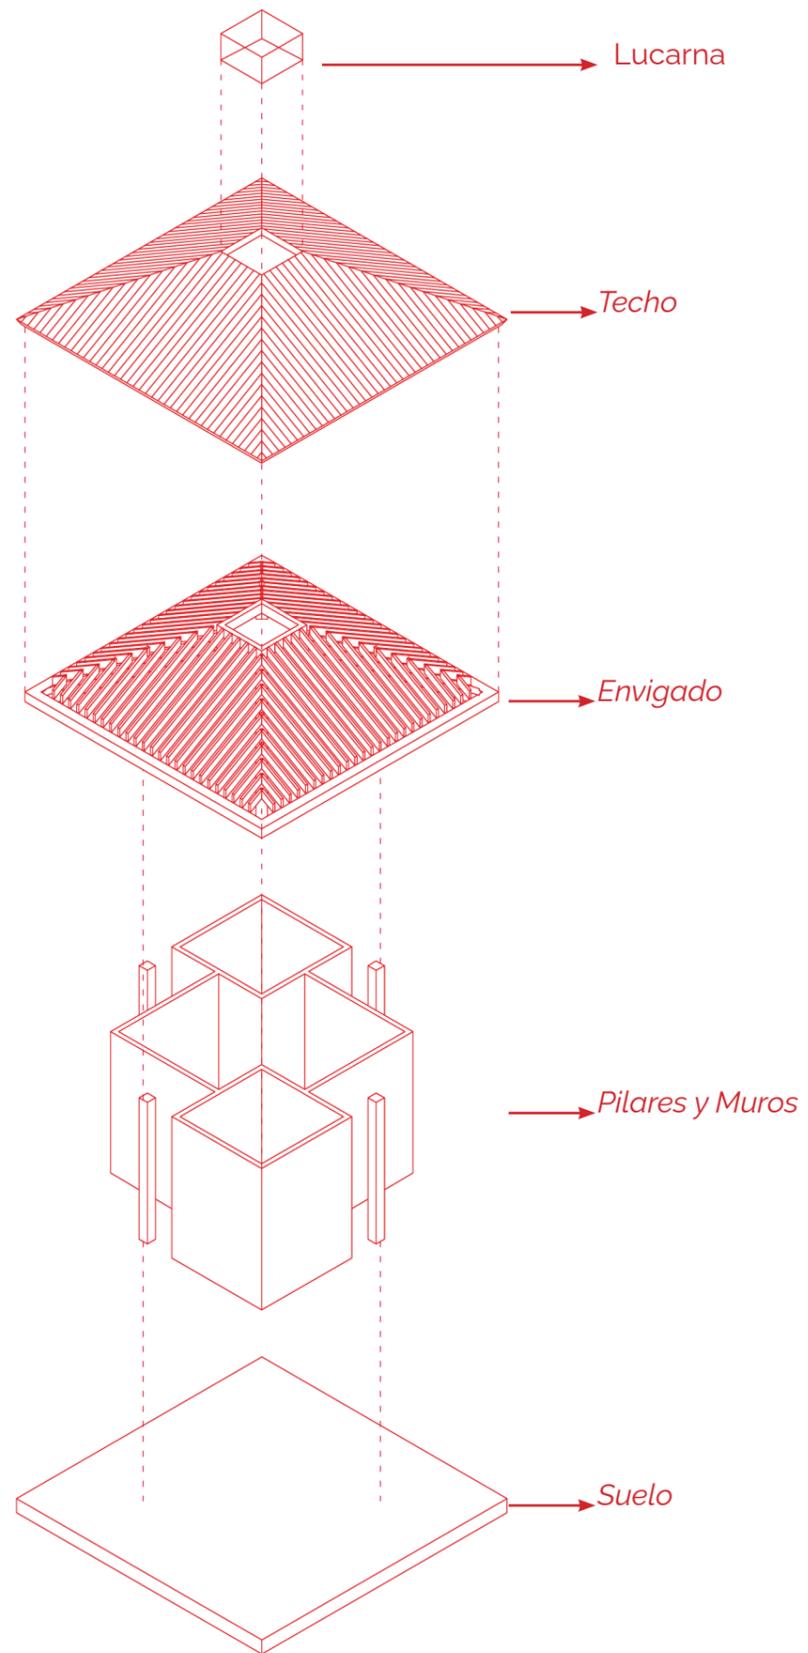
Estructura de Módulo / Fuente: Elaboración propia (2021)
